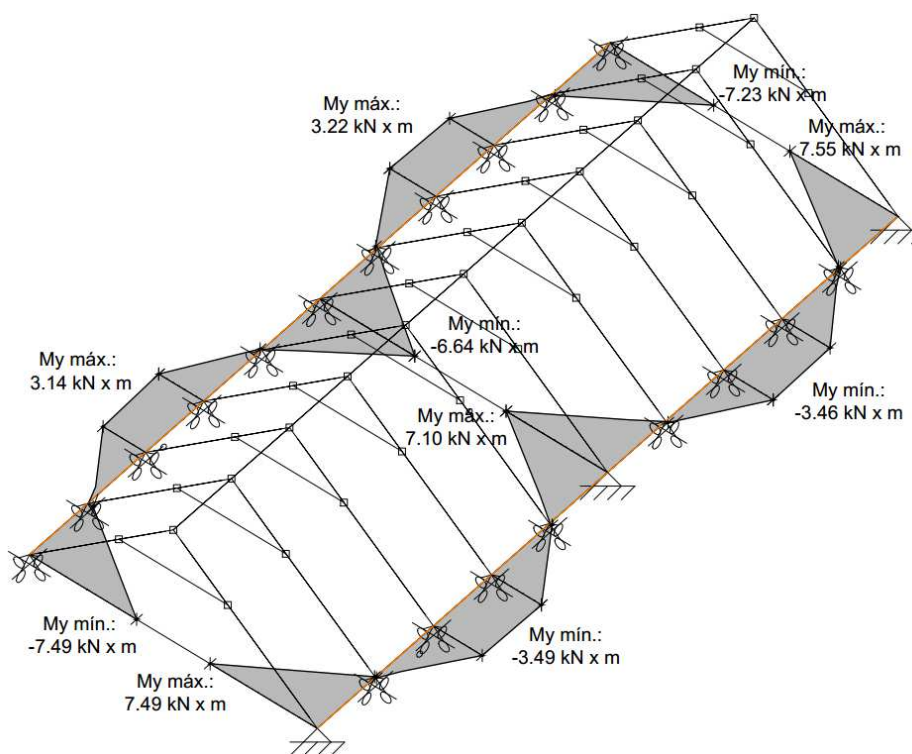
Diagrama de momentos flectores en el plano horizontal de la viga-durmiente de hormigón
